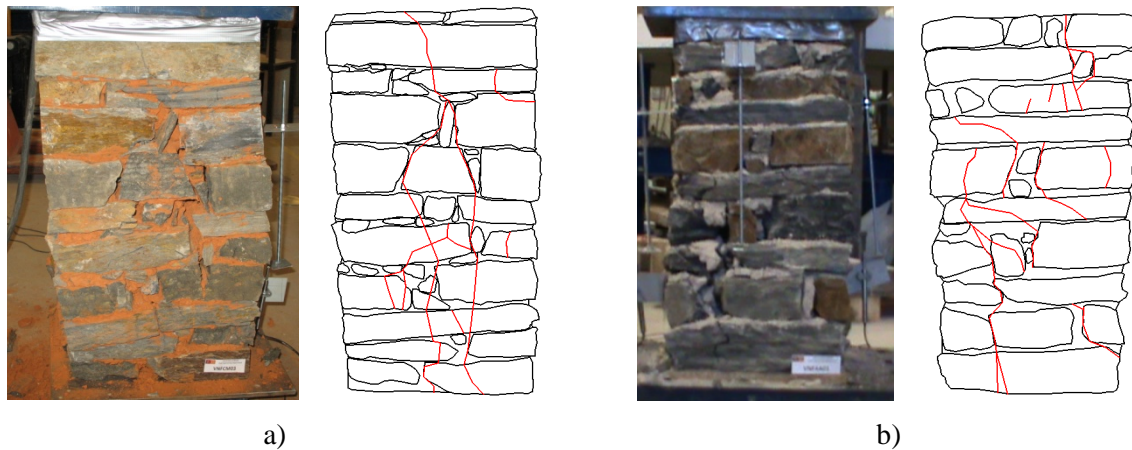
Padrão típico de fissuração de prismas ensaiados em compressão axial: a) Prismas com argamassa de terra; b) Prismas com argamassa de terra artificial.
